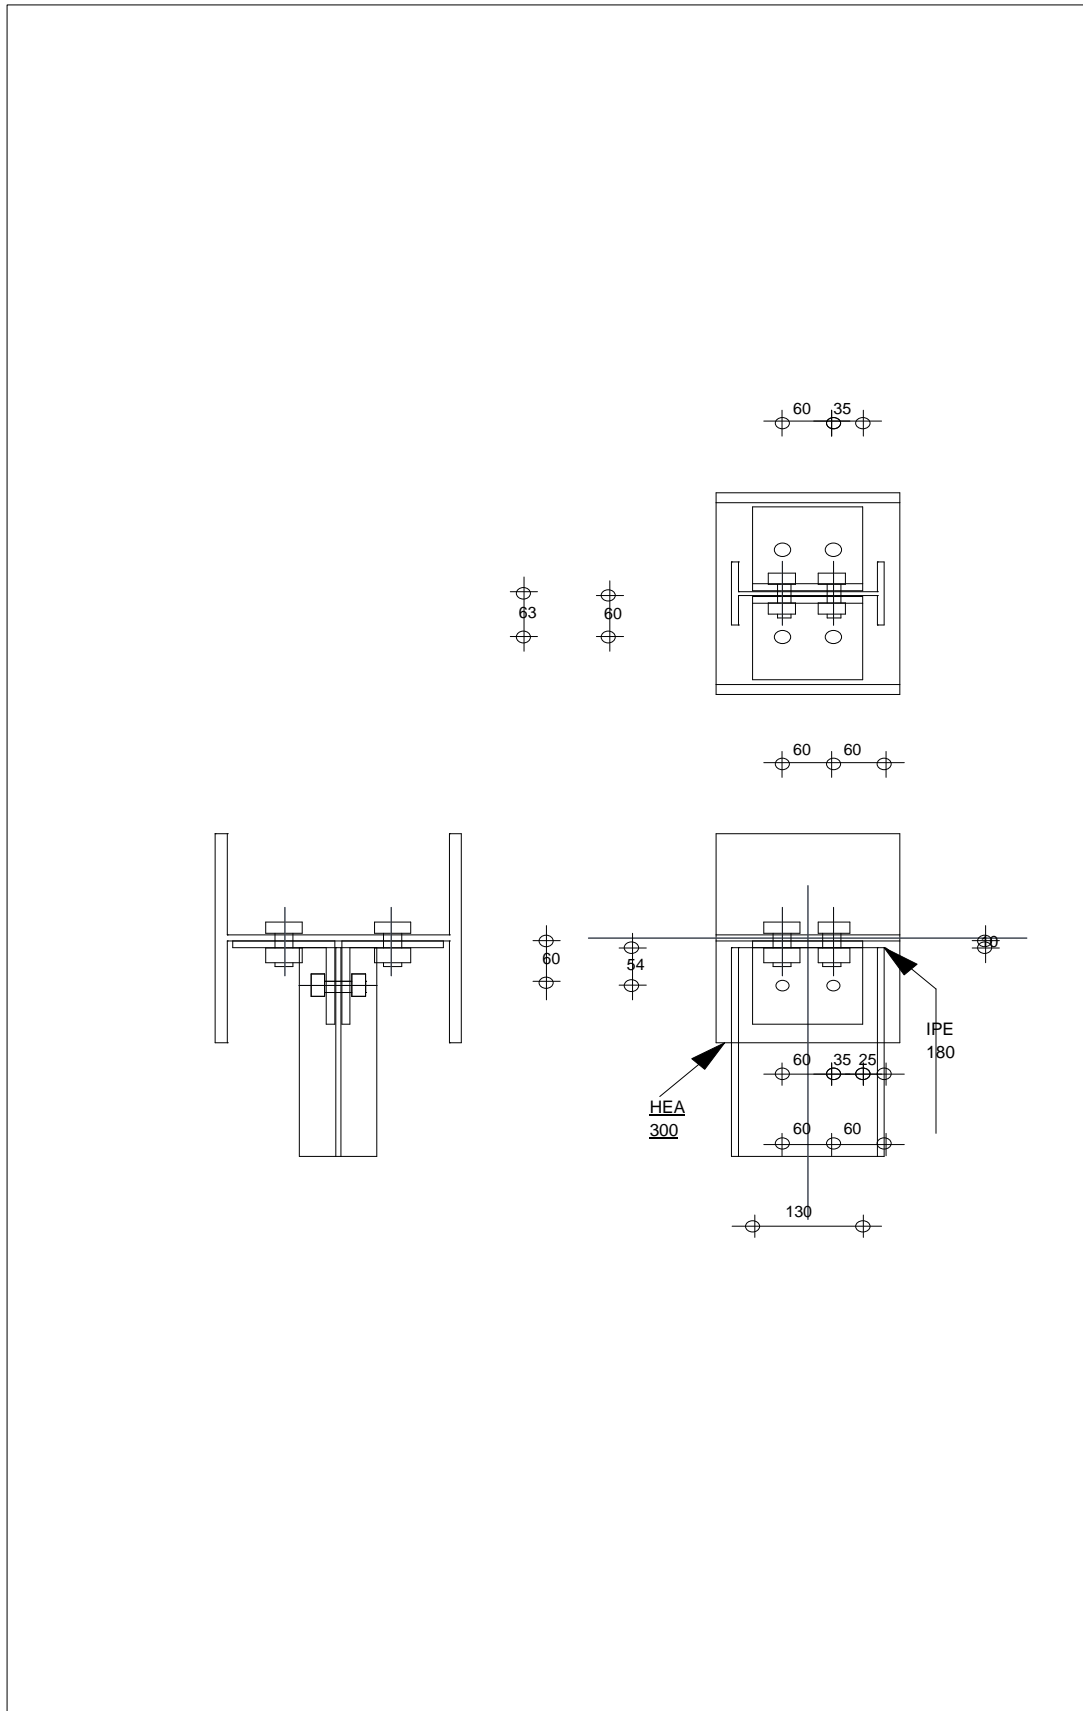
Schéma d'assemblage poteau-poutre secondaire.
